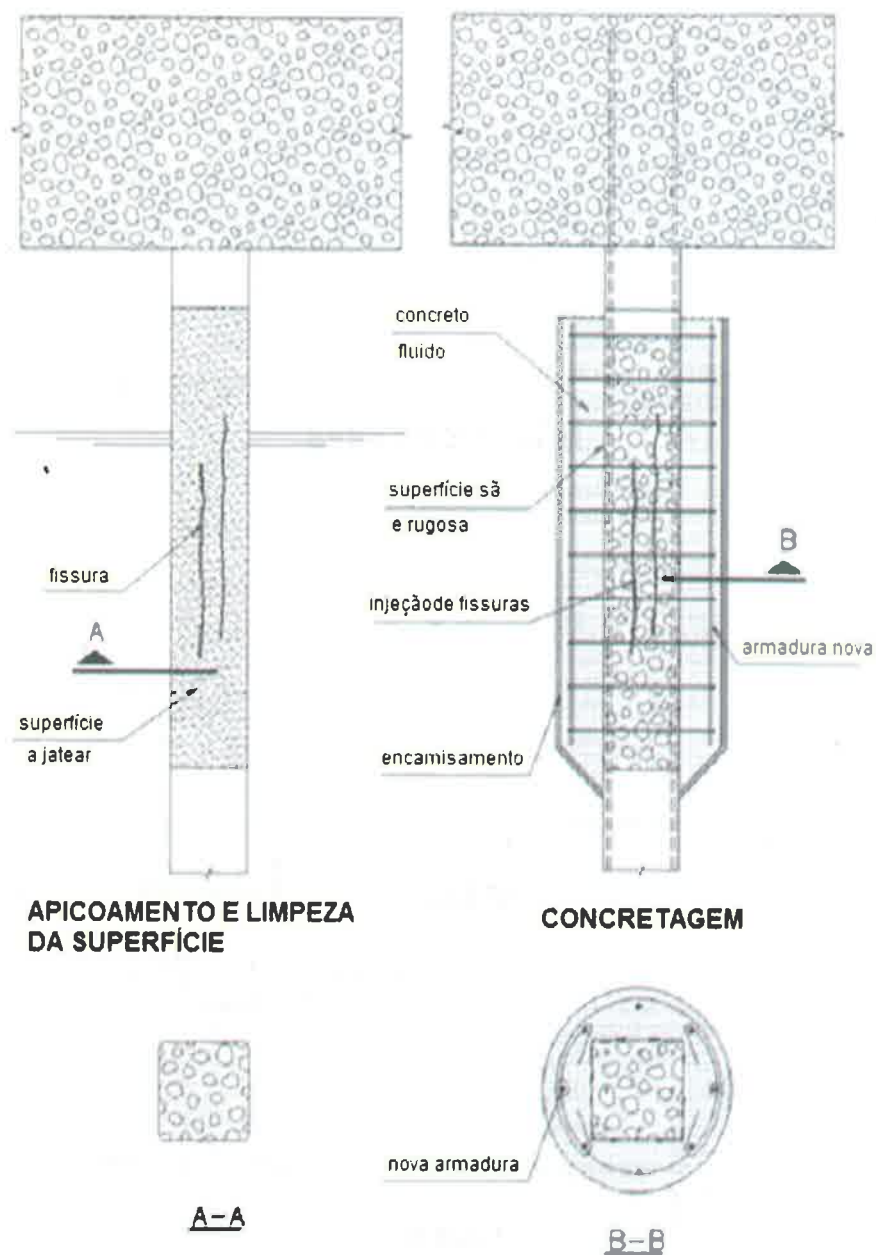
Reparo de pilares mediante encamisamento.
